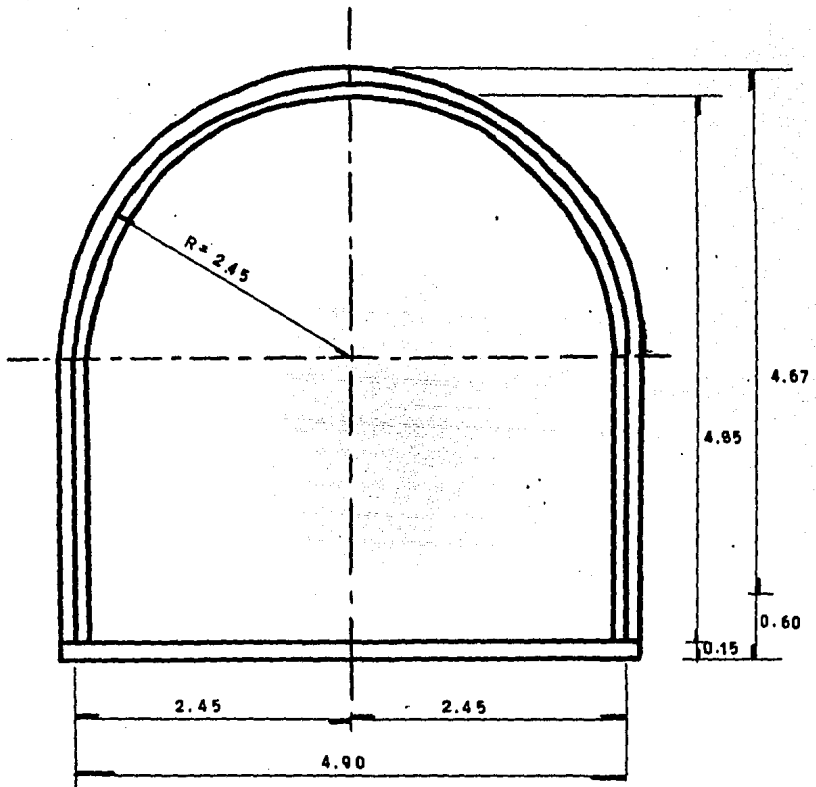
SECCION PARA GALERIA DE INTERCONEXION DE TUNELES
